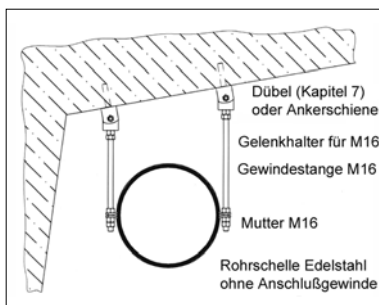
Befestigung für Brücken-entwässerungsleitungen
